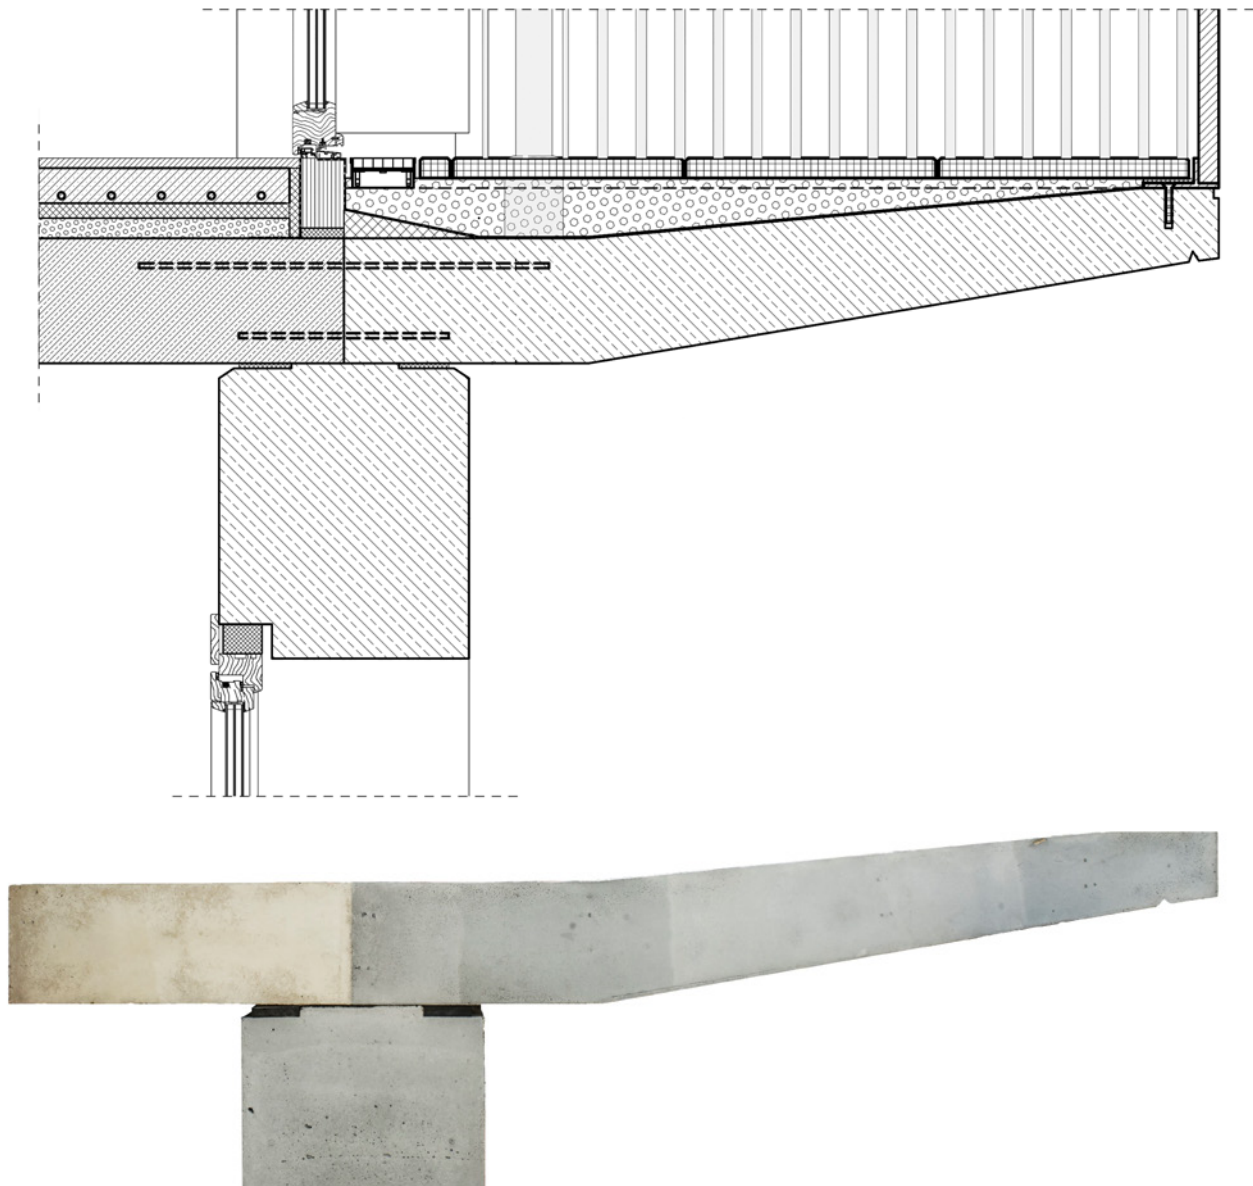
Detailanschluss Balkon aus ILC mit Rückverankerung
